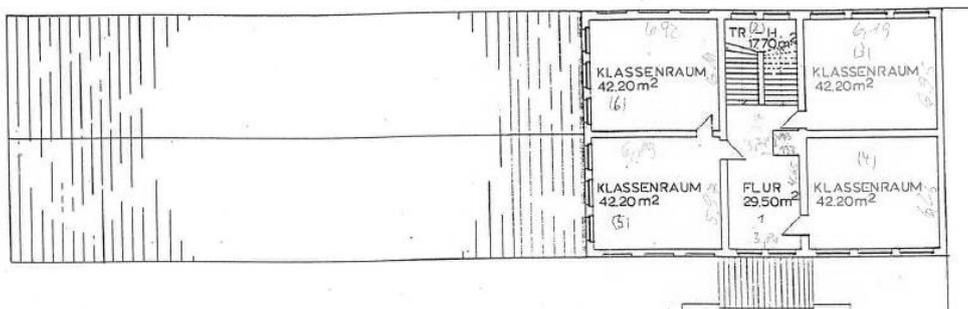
Grundriss der Sporthalle und Nebengebäude (Quelle ZGM)
